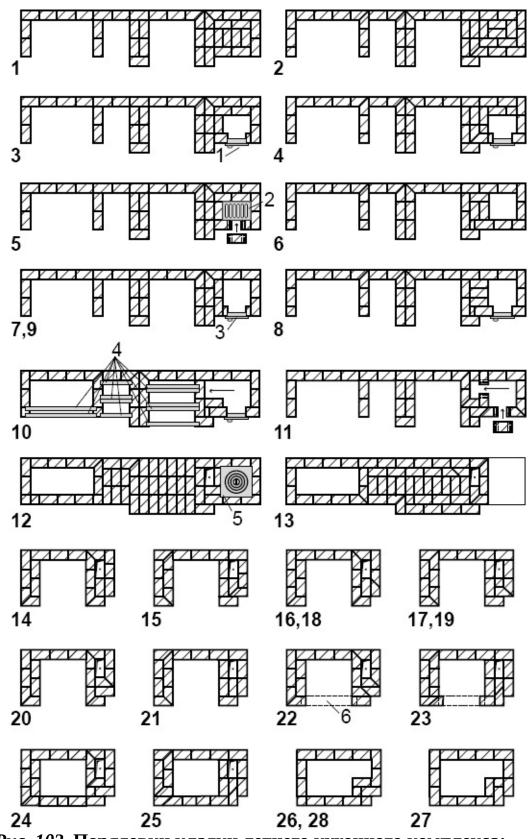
Порядовки кладки летнего кухонного комплекса: 1- дверца зольника; 2- колосниковая решетка; 3- дверца топки; 4-
